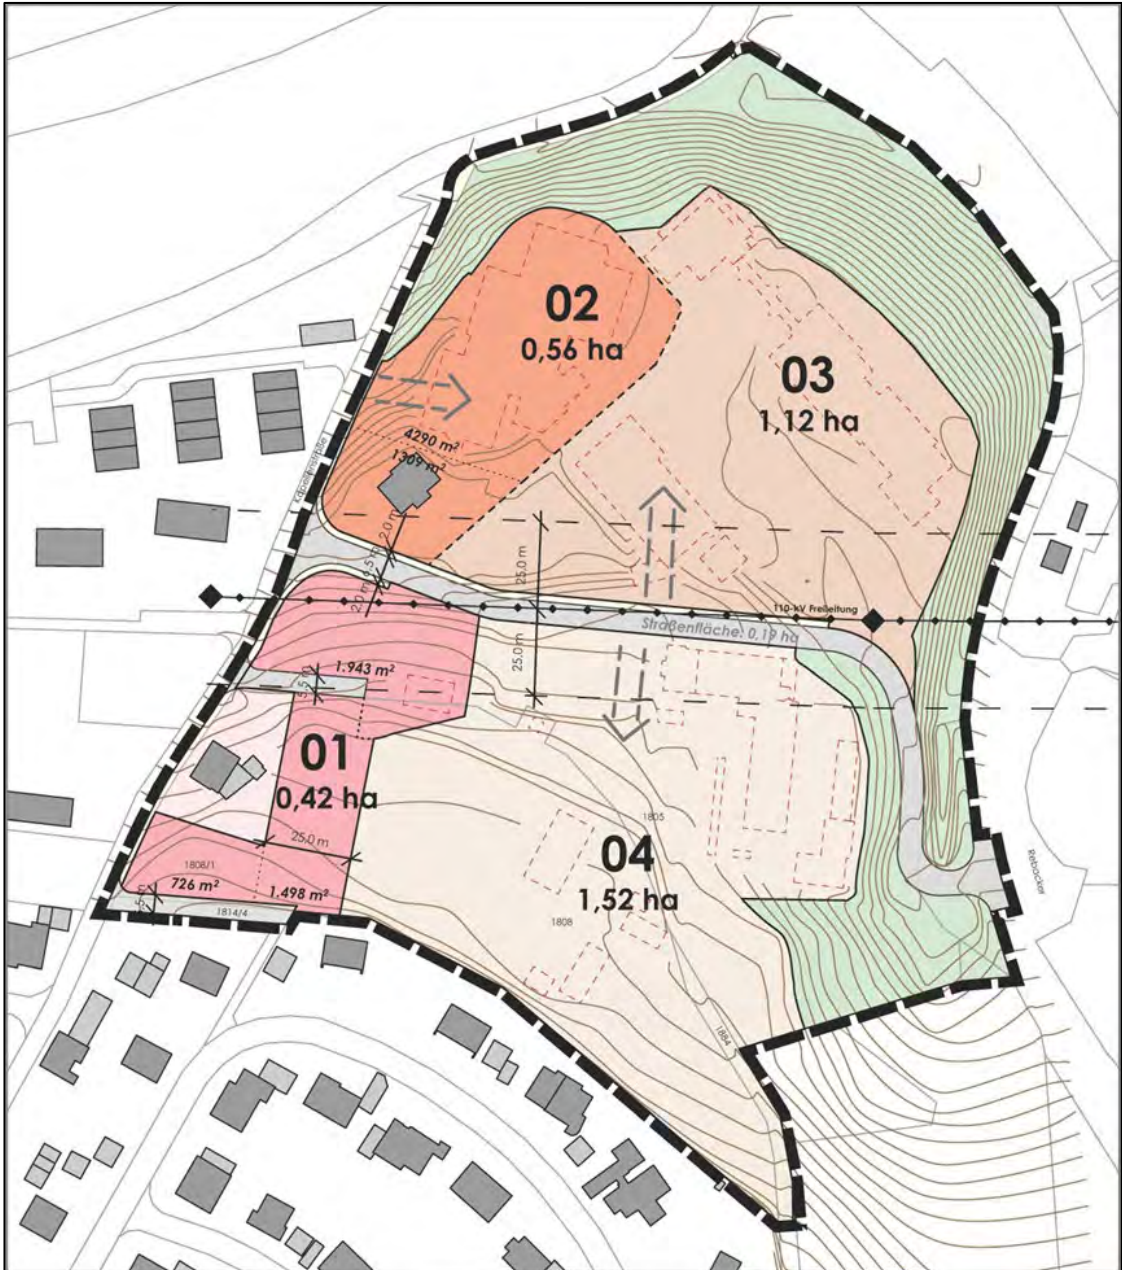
Rahmenplan mit flächiger Darstellung der zu entwickelten Bausteine 01 - 04. Quelle: Stadtbau Lörrach, 2021.
